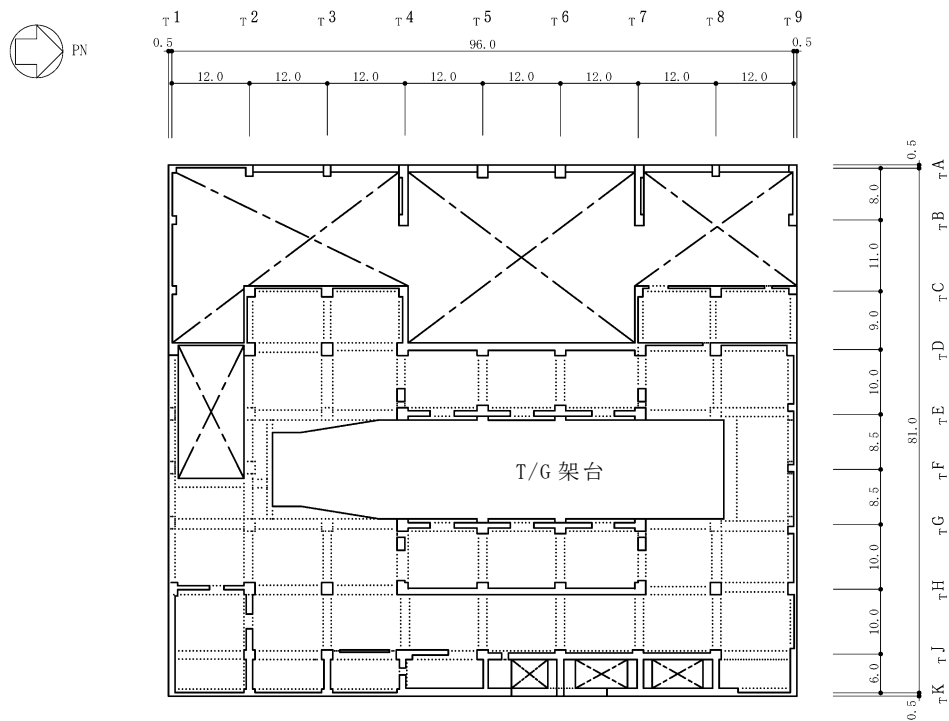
タービン建屋の概略平面図 (2F, T.M.S.L. 20.4m) (4/6) (単位 : m)
